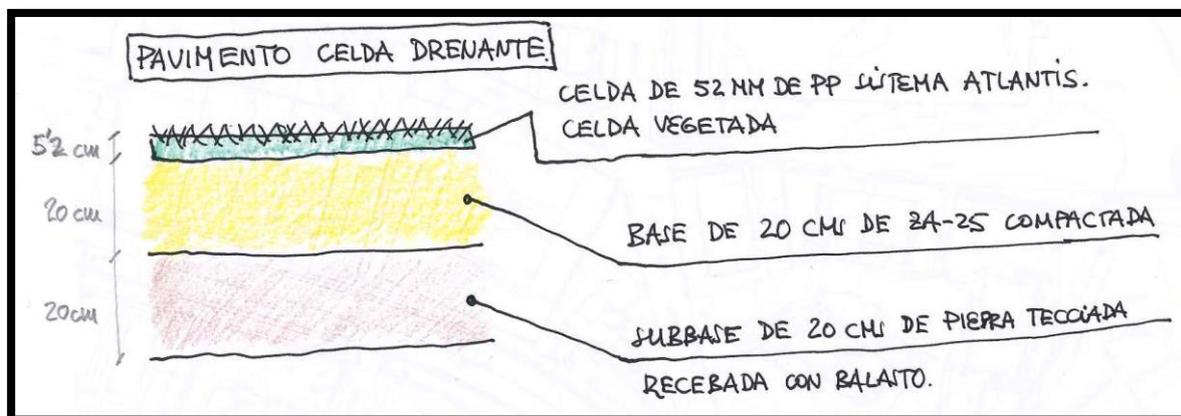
Croquis del detalle del pavimento drenante con celda Atlantis
